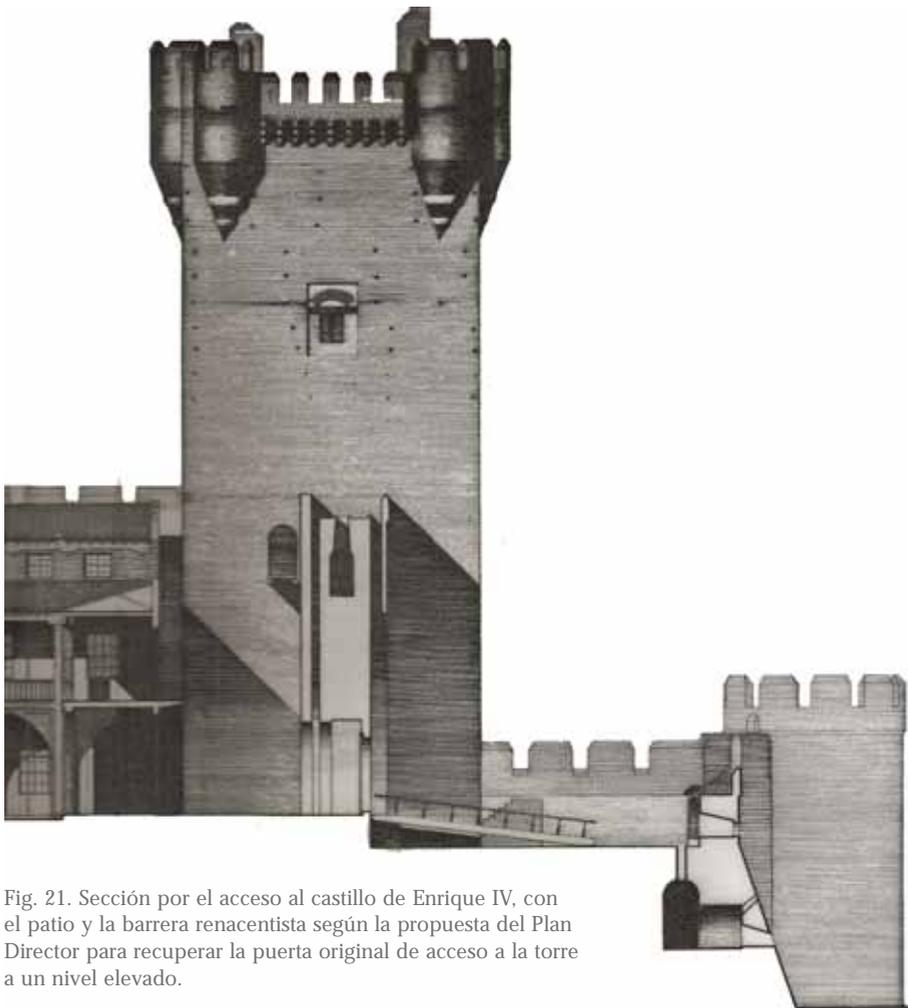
Sección por el acceso al castillo de Enrique IV, con el patio y la barrera renacentista según la propuesta del Plan Director para recuperar la puerta original de acceso a la torre a un nivel elevado.
